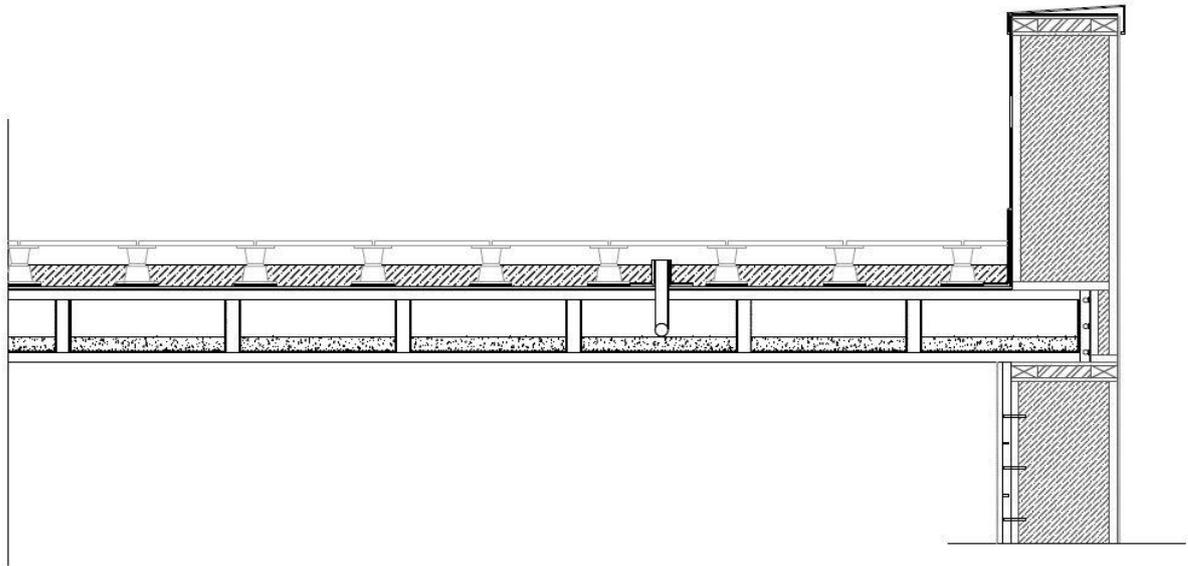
Detalle de cubierta aljibe. Fuente: Elaboración propia.
